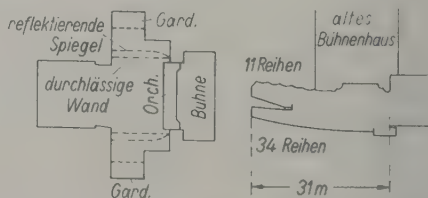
Grundriß und Längsschnitt der Staatsoper Hamburg.
